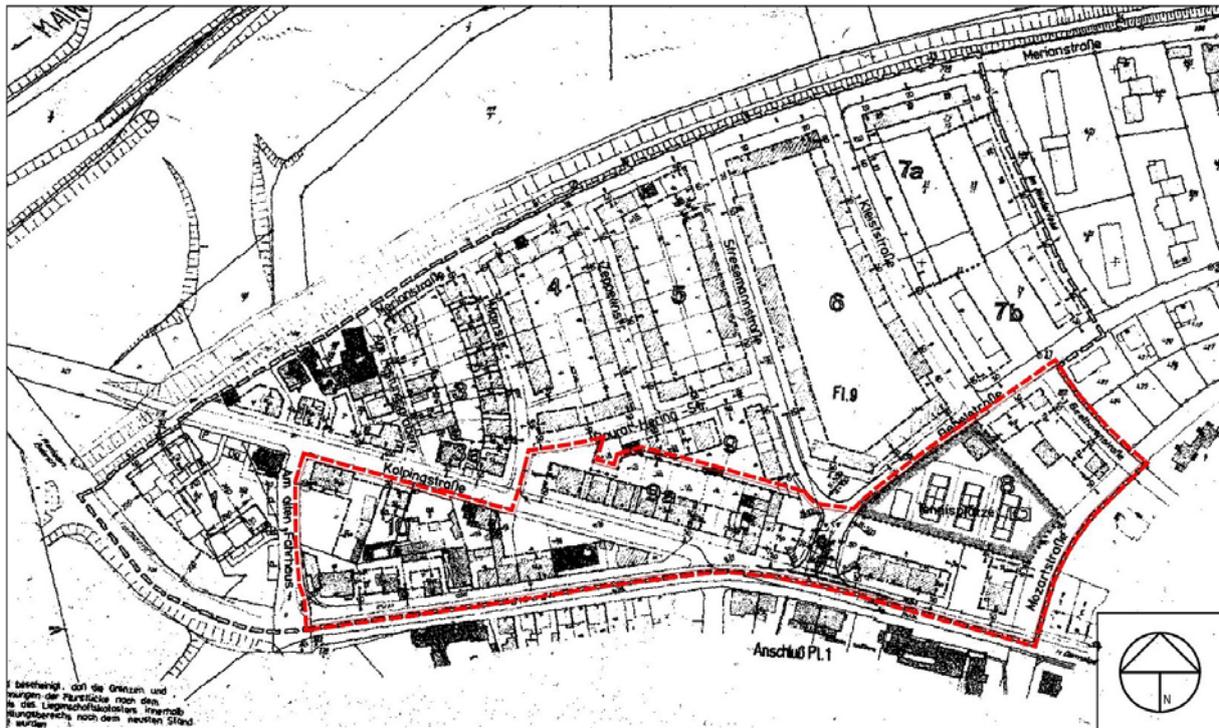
Lage des Geltungsbereichs der Teilaufhebung im Bebauungsplan „Am Alten Fährhaus“
